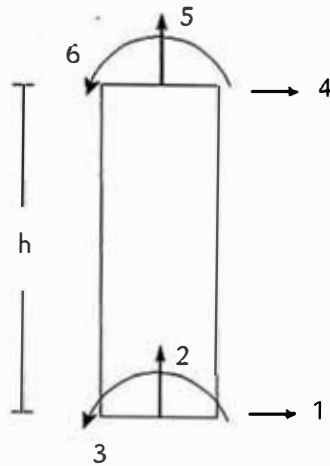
Grados de libertad considerados para un elemento columna (o placa)
